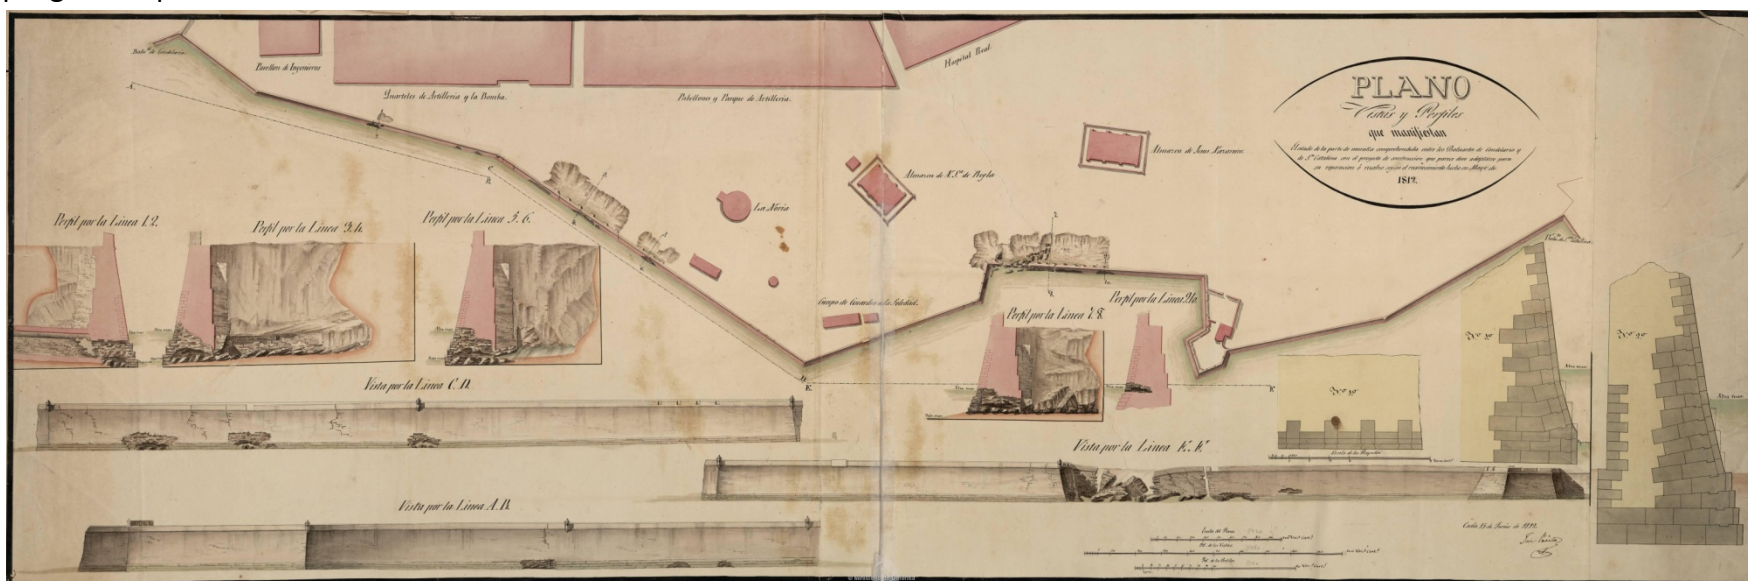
Plano Vistas y Perfiles que manifiestan El estado de la parte de muralla comprendida entre los Baluartes de Candelaria y de Sta. Catalina con el proyecto de construcción que parece debe adoptarse para su reparación ó recalzo según el reconocimiento hecho en Mayo de 1812 / José Prieto.
